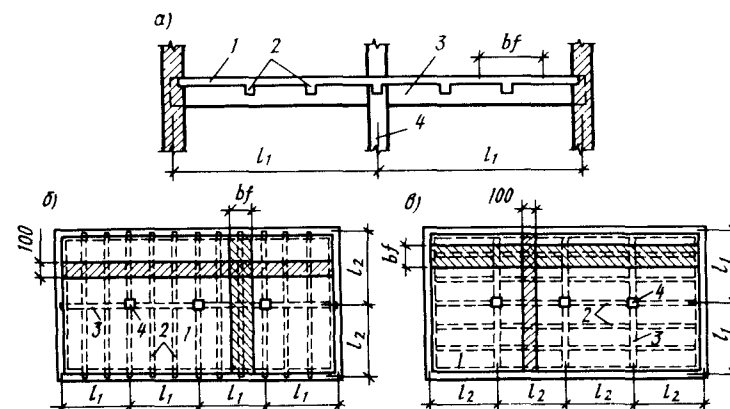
Конструктивные схемы монолитных ребристых перекрытий с балочными плитами: 1 — плита; 2 — второстепенная балка; 3 — главная балка; 4 — колонна
